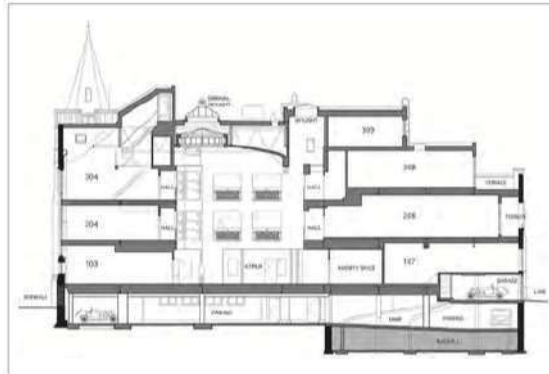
“The Church Lofts” Sección transversal Oeste–Este mirando al Norte / Arq. Bernard Watt, 2009
